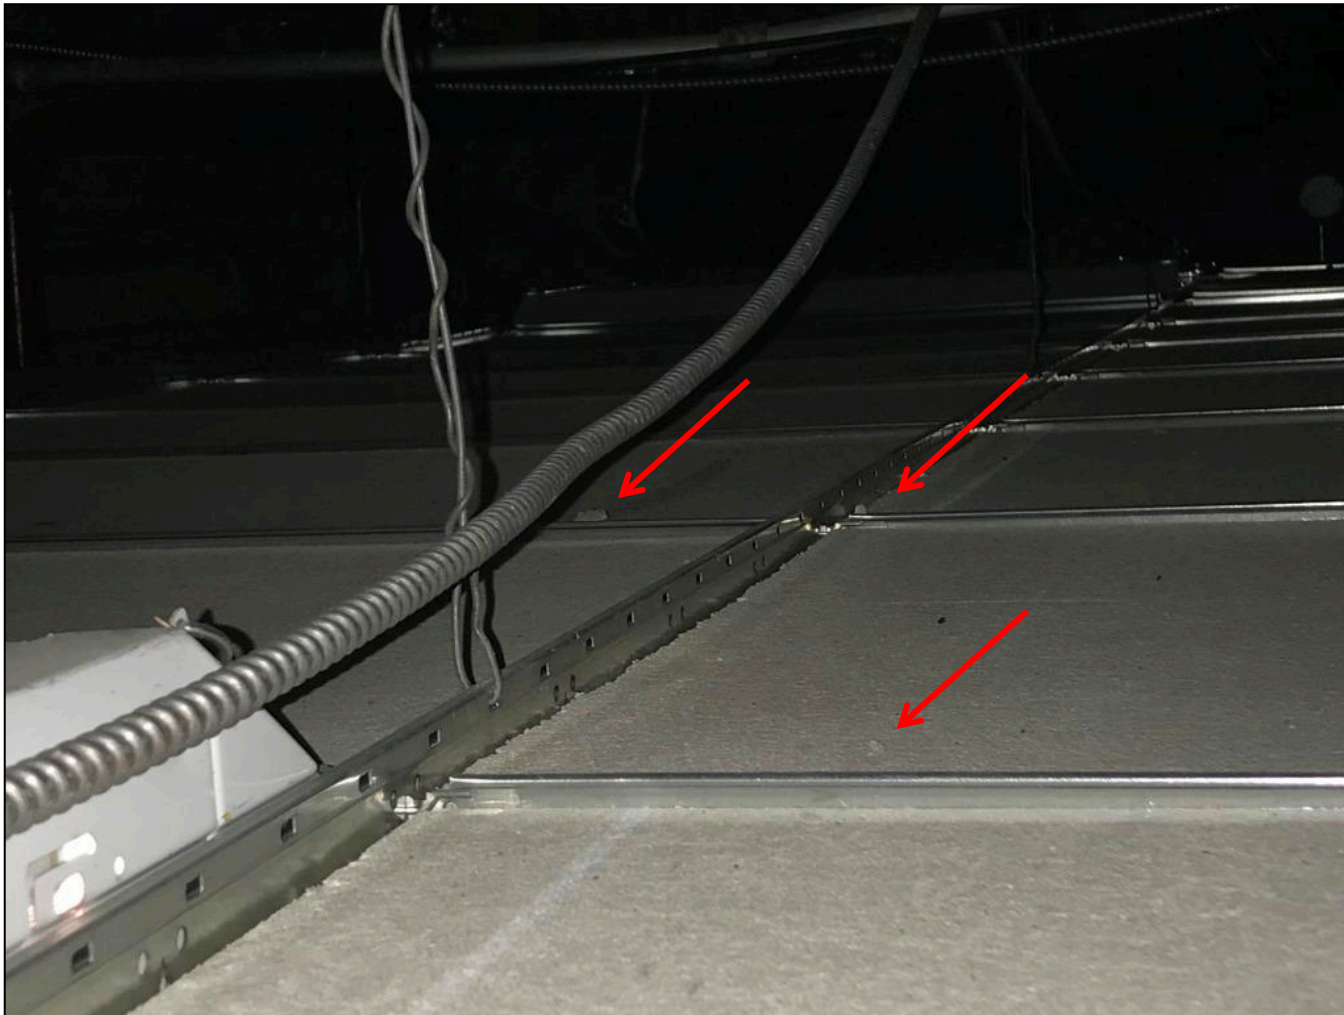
Vue de petites quantités de débris de mortier et/ou vermicrete au-dessus des tuiles de plafond (salle 107)
